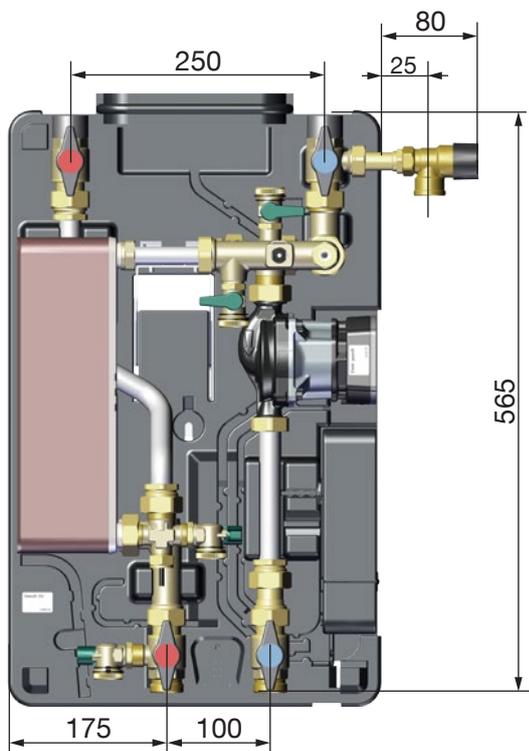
Dimensiones de la Regumaq X-45 con accesorios
